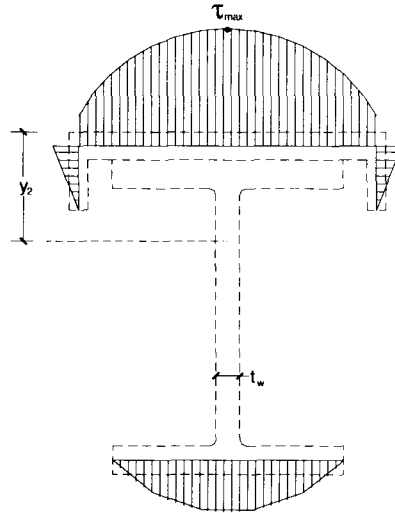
Distribución de esfuerzo cortante en una sección compuesta por un canal y perfil W debido a carga horizontal
